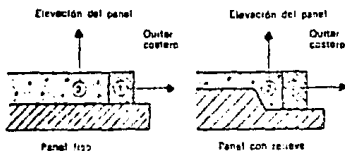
Moldes cerrados y moldes convencionales.
